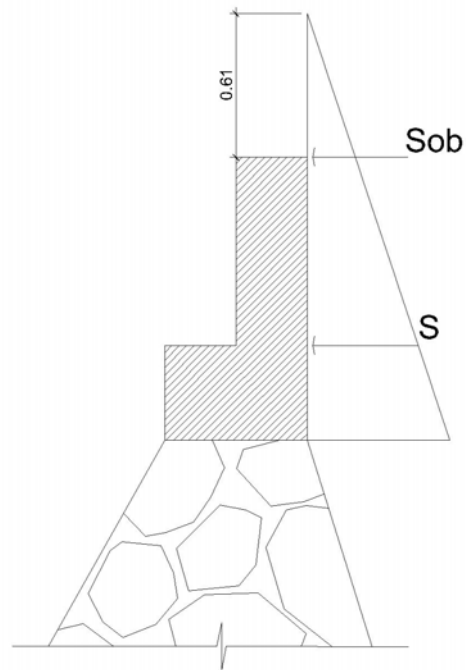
Dimensionamiento de la viga de apoyo y cortina
